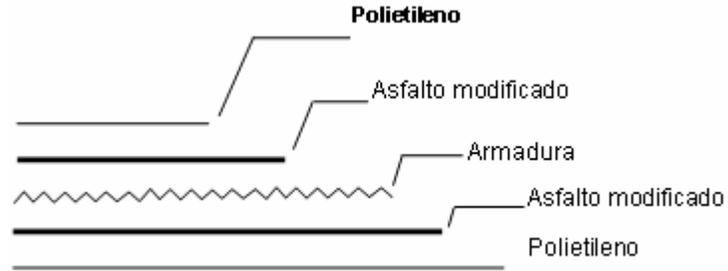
Estructura de la lámina monocapa sin autoprotección
